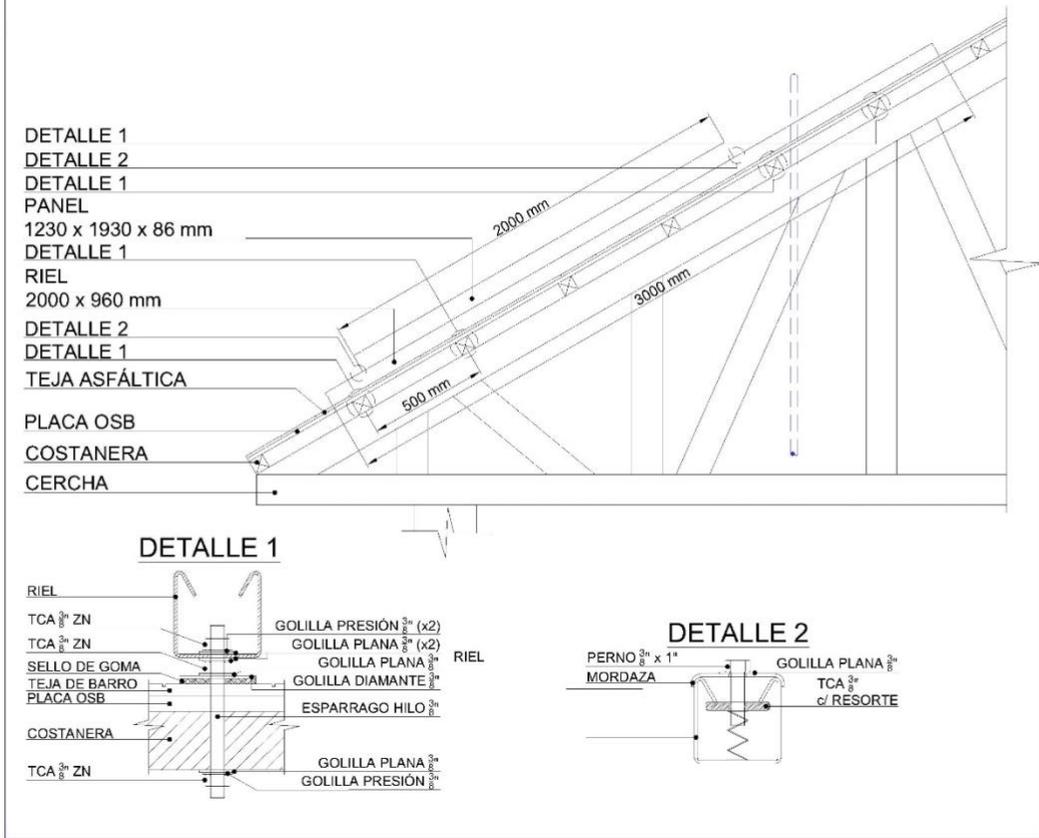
Detalle 8 panel solar, anclaje a la cubierta, elaboración propia
